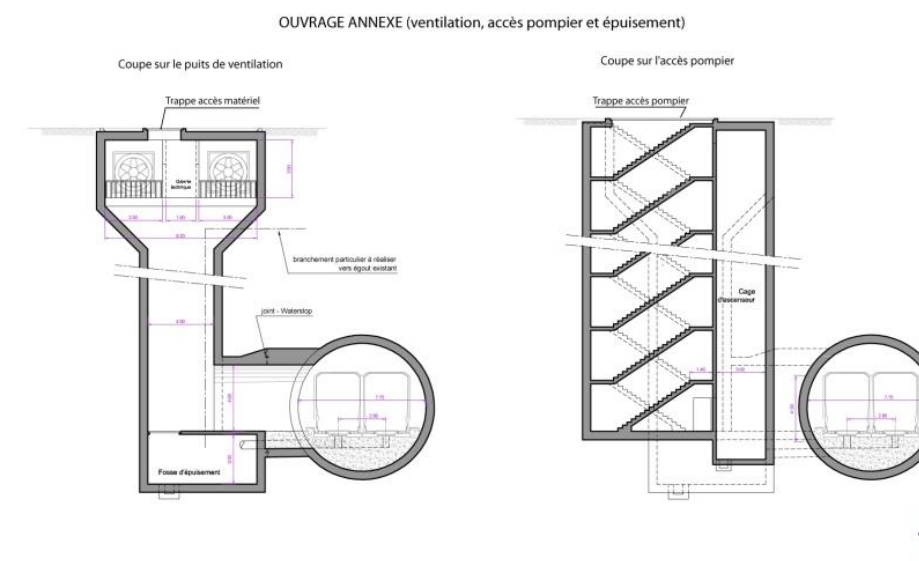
Coupes des ouvrages puits de ventilation et accès pompiers (Source : RATP)
